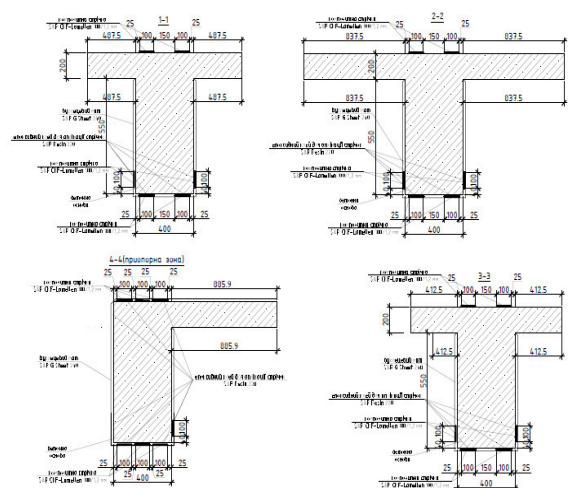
Вузли посилення залізобетонного перехресно-ребристого перекриття на відм. +11.880 в осях 1-5, В-Г
